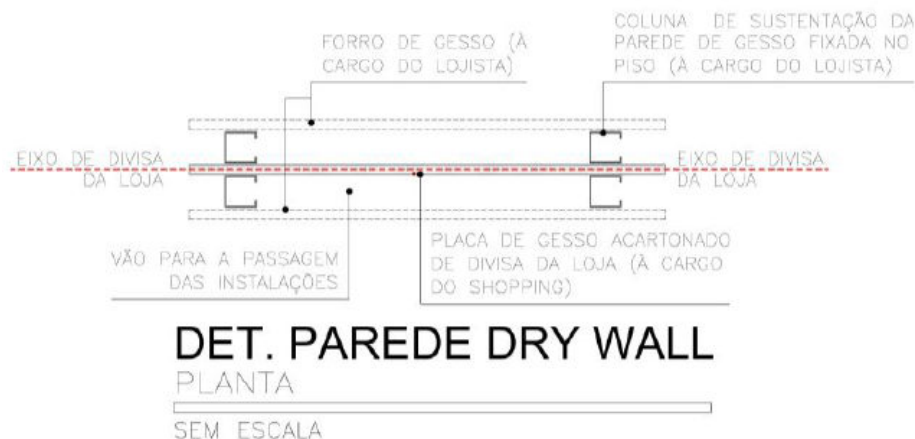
Detalhe Dry Wall/Passagem de Infraestrutura
